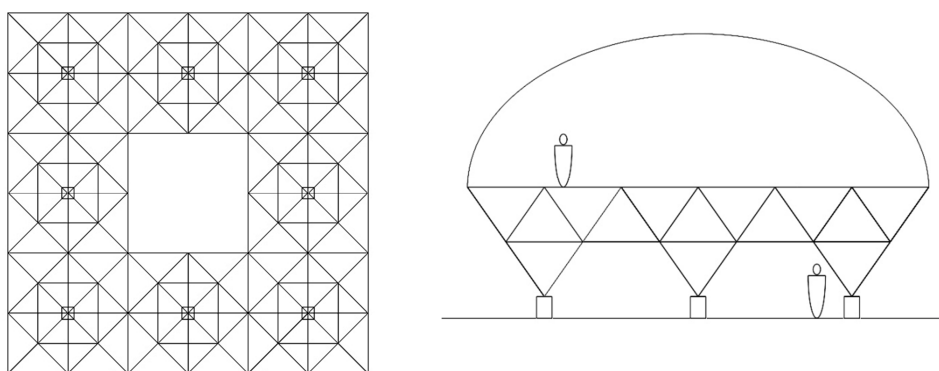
Desenho eletrônico em planta e vista dos estudos do novo laboratório – (CAMPOS, 2009).
